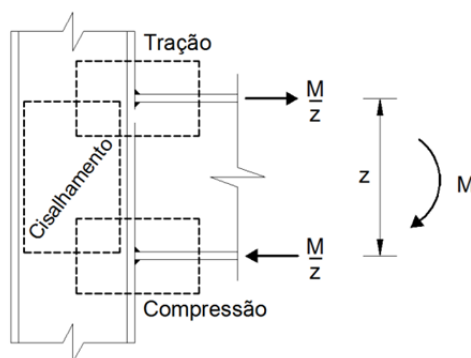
Regiões de tração, compressão e cisalhamento de uma ligação viga-pilar.
